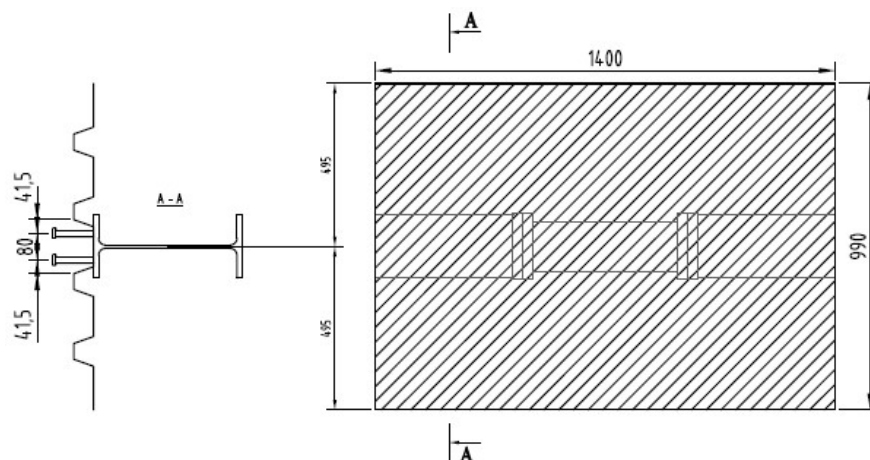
Placa din beton pentru linkurile cu placa de capat.
